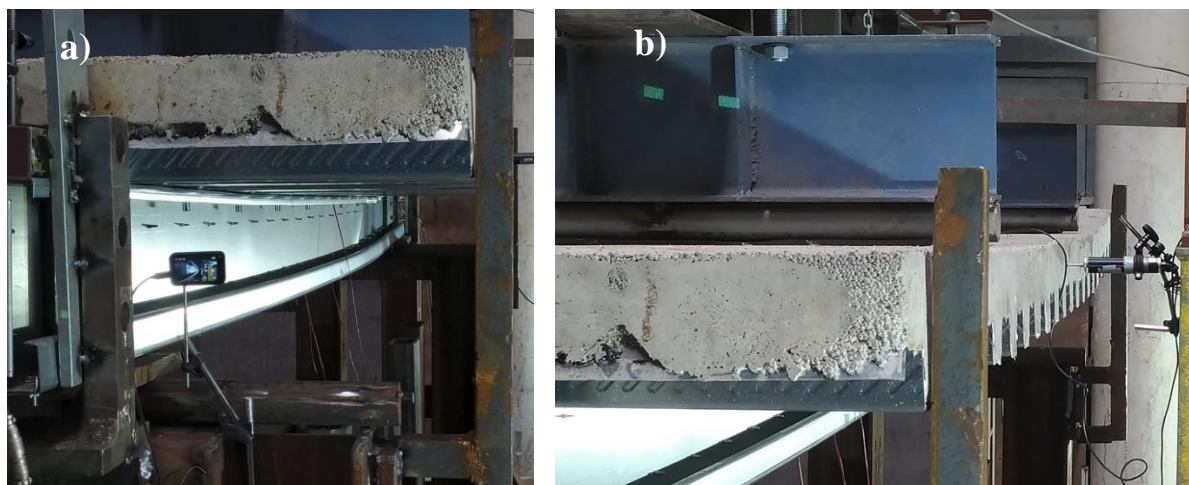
Deformada, a) Vista inferior, b) Vista superior
